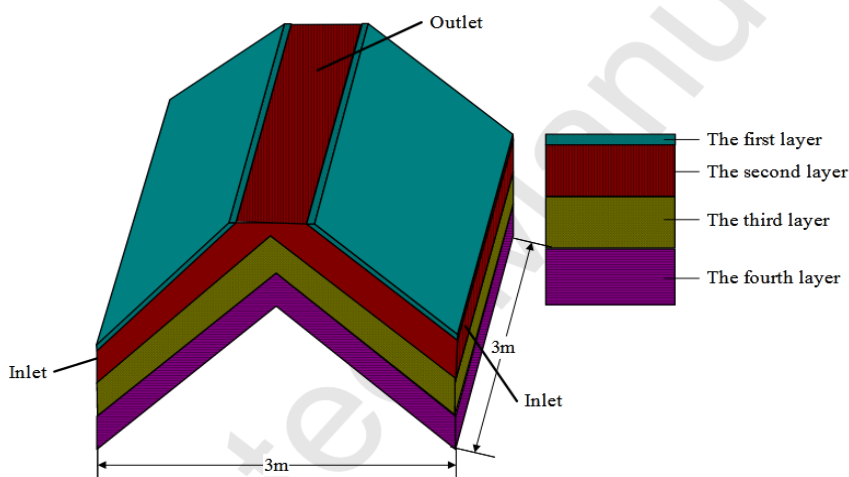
Construction de toit (Gauche : construction sceptique ; Droite : détails de construction) (D. Li et al., 2016)
